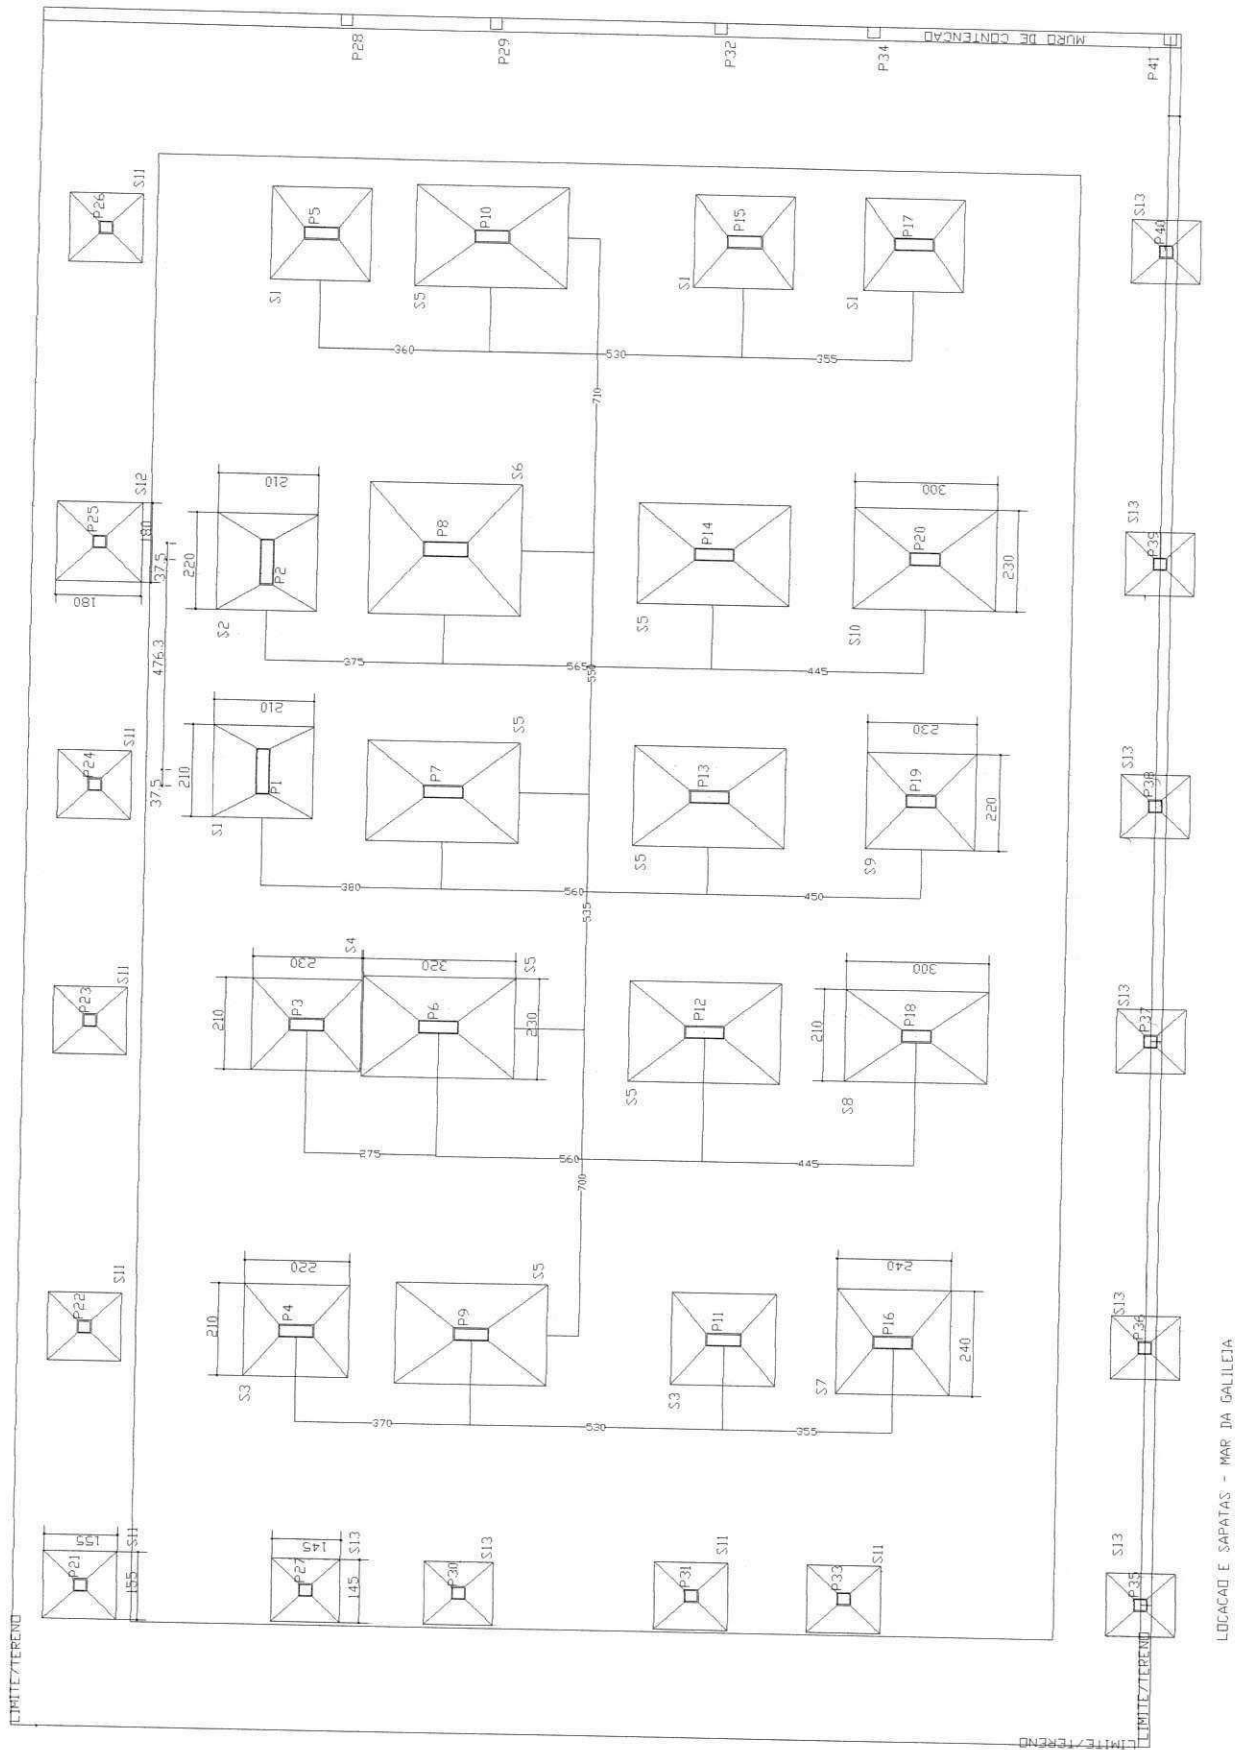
Planta de locação dos pilares e das sapatas – Edifício Mar da Galiléia.
